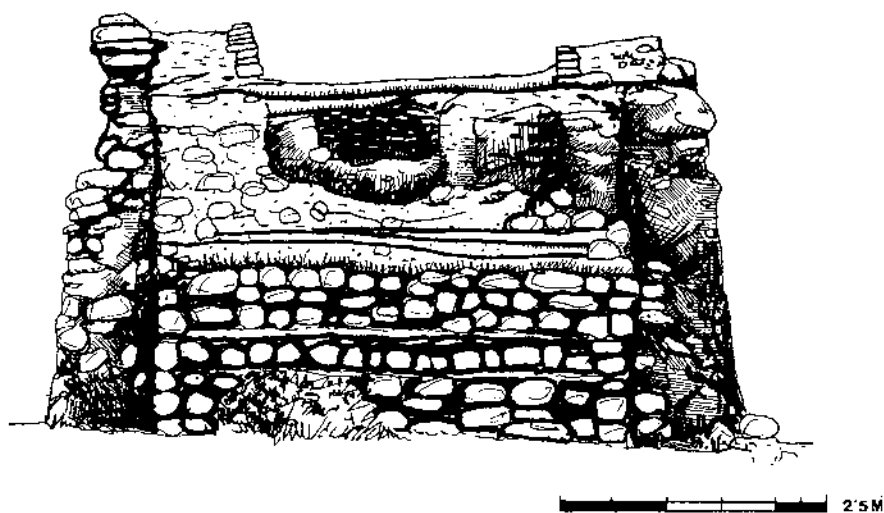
Alzado de puente de Torre Quebrada, extraído de fotografías anteriores a su destrucción.
